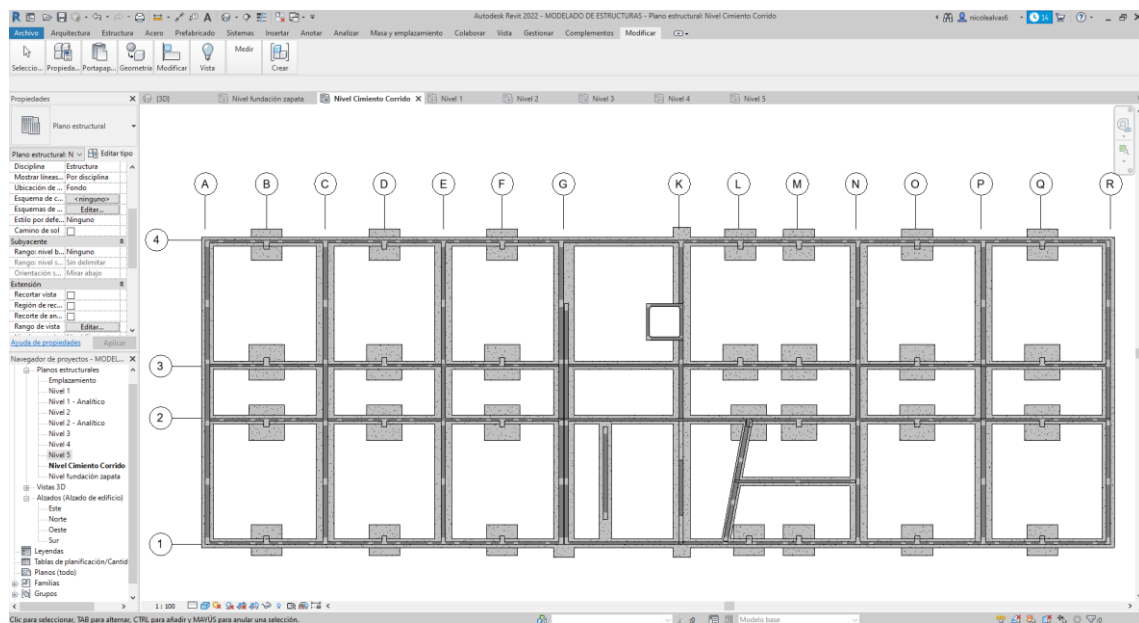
Modelo 3D – Vista en planta del nivel Cimiento corrido
